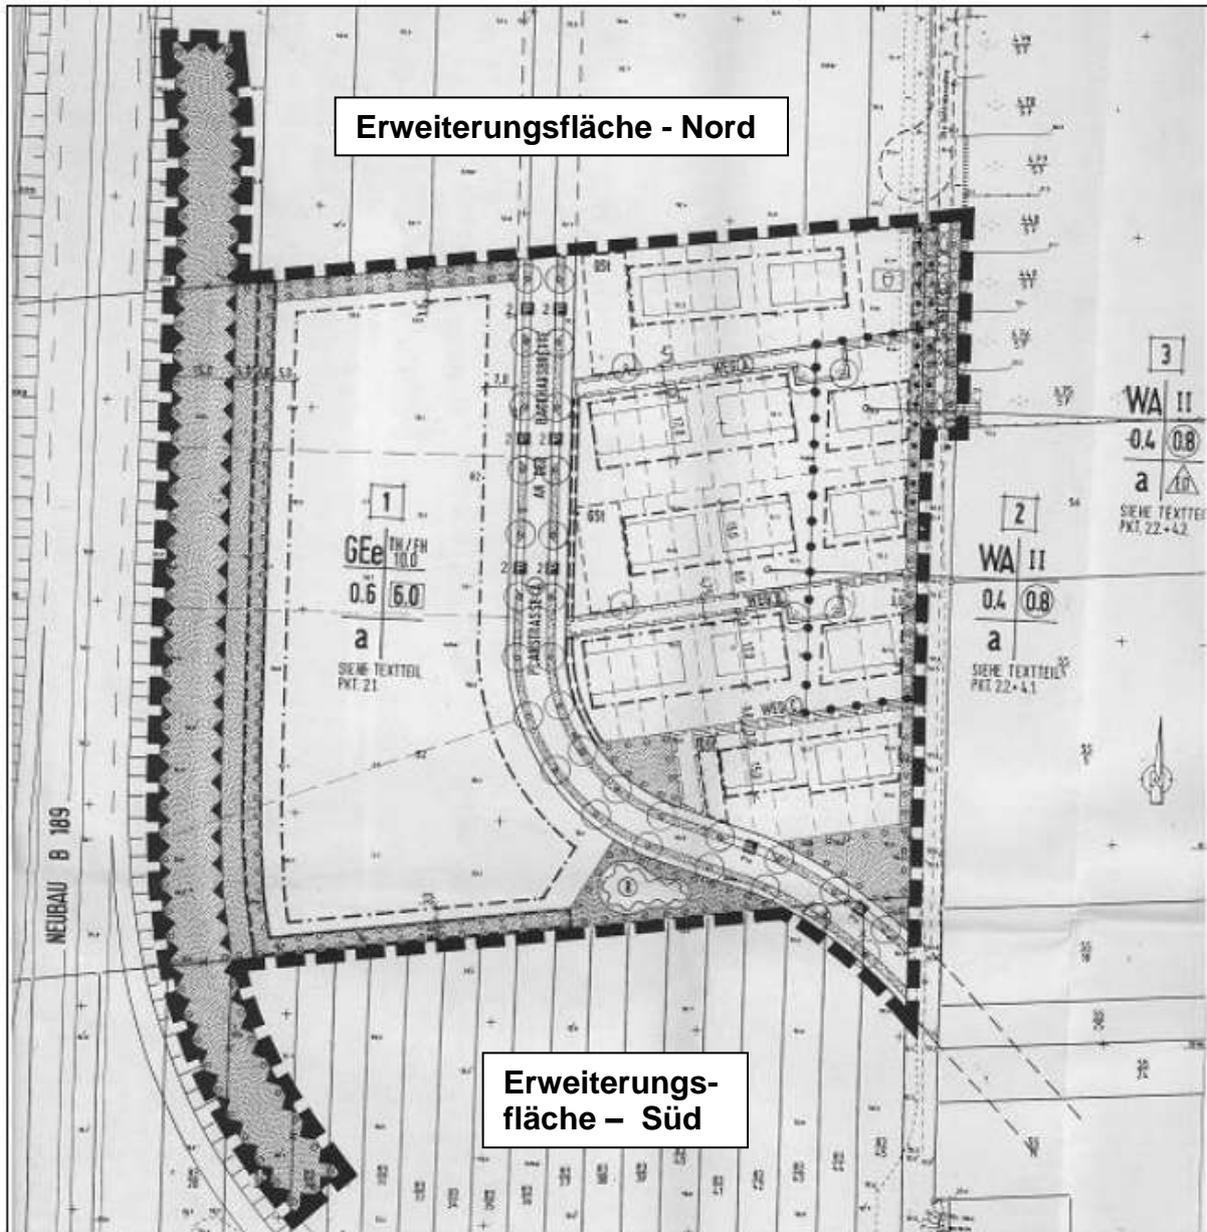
Übersichtsplan für den bisher gültigen Bebauungsplan Nummer 9
